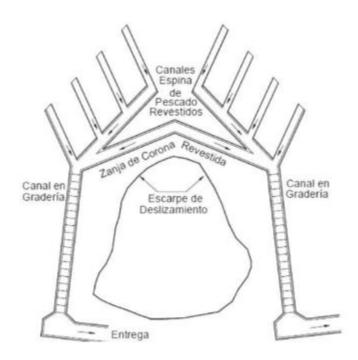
Esquema en planta de canales colectores. Espina de Pescado (Suarez, J.2010)
